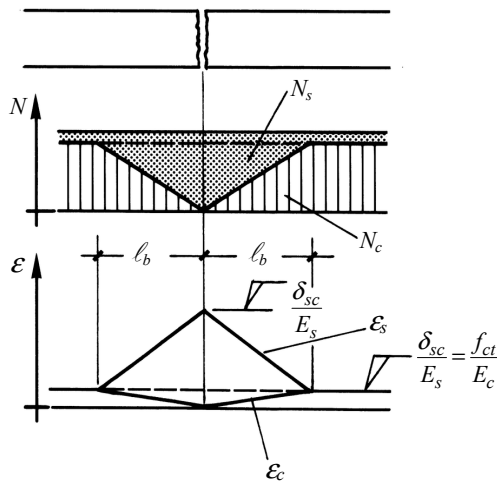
Kraft- und Dehnungsverlauf von Beton und Bewehrung in Rissnähe
